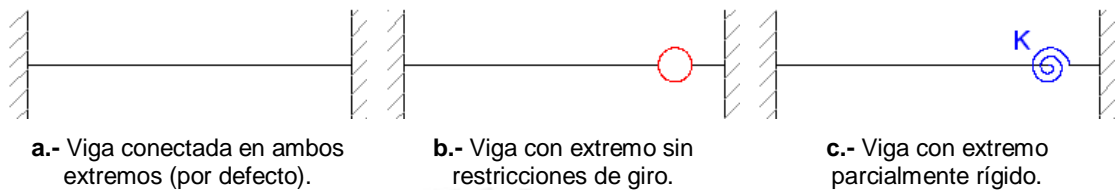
Tipos de conexiones que se pueden modelar.
